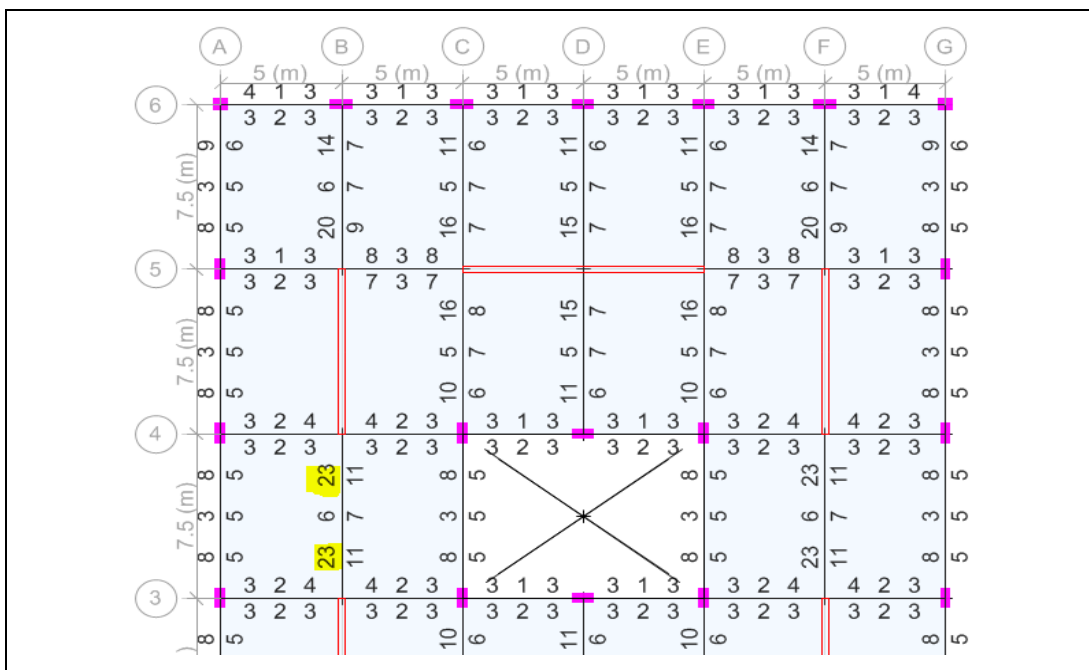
Área de refuerzo longitudinal en Vigas (5to Nivel).
